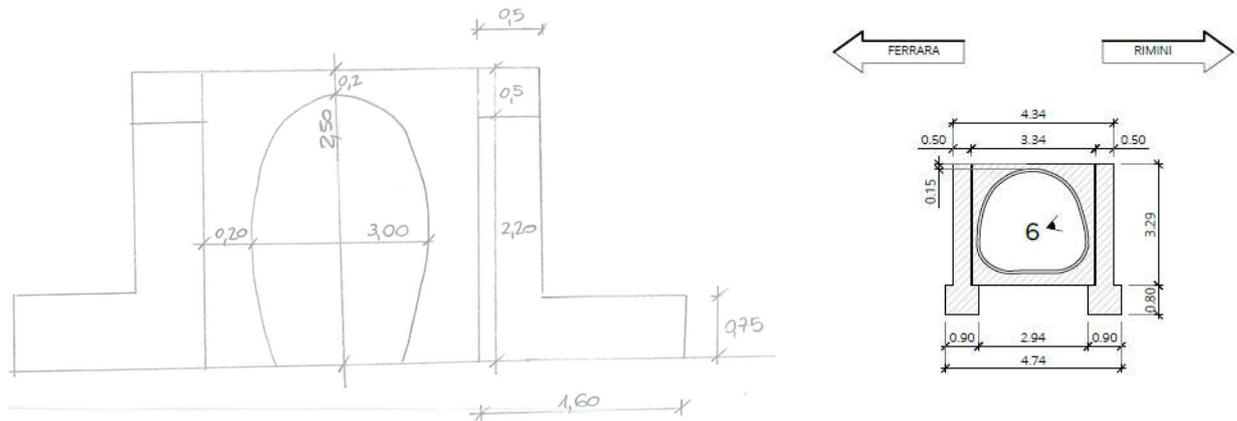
Prospetto sud da sopralluogo e sezione trasversale stato di fatto
